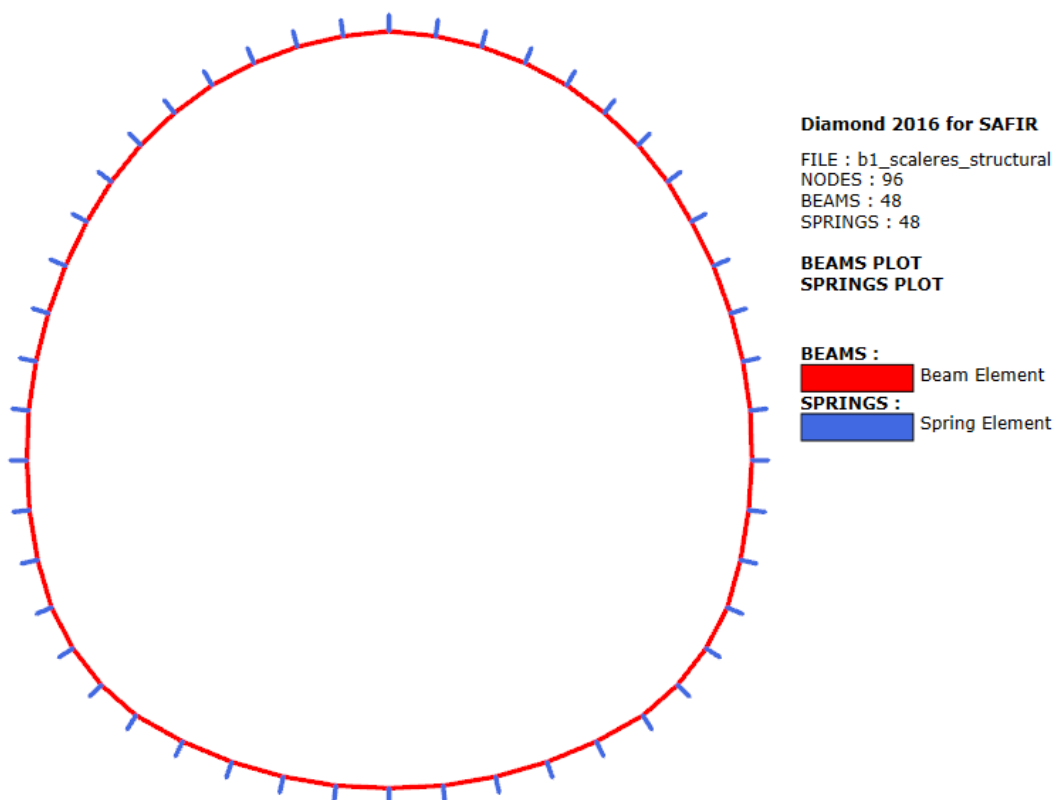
Sezione B1 rappresentata tramite elementi 'beam'
